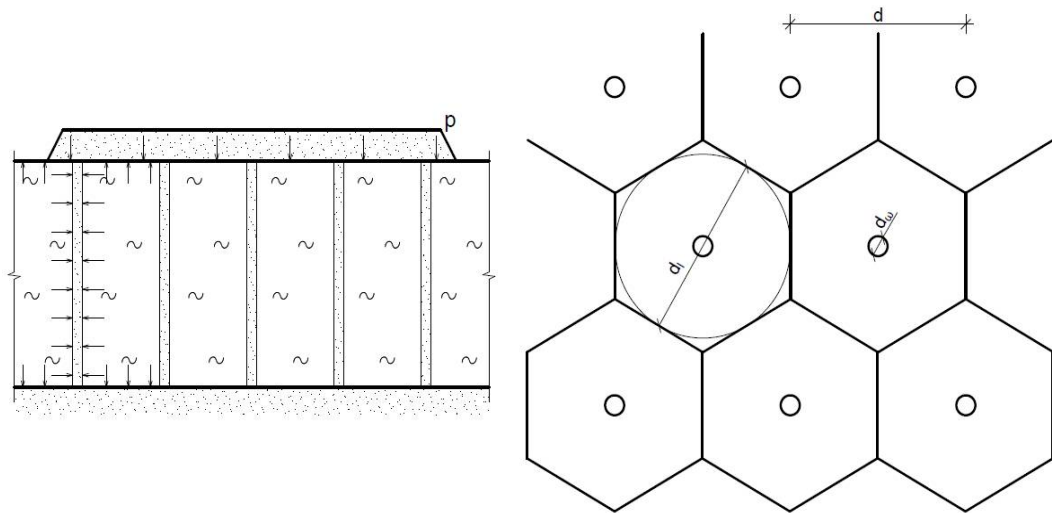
Розрахункова схема водонасиченого сильностисливого ґрунту, привантаженого фільтраційним шаром (дренована основа)
